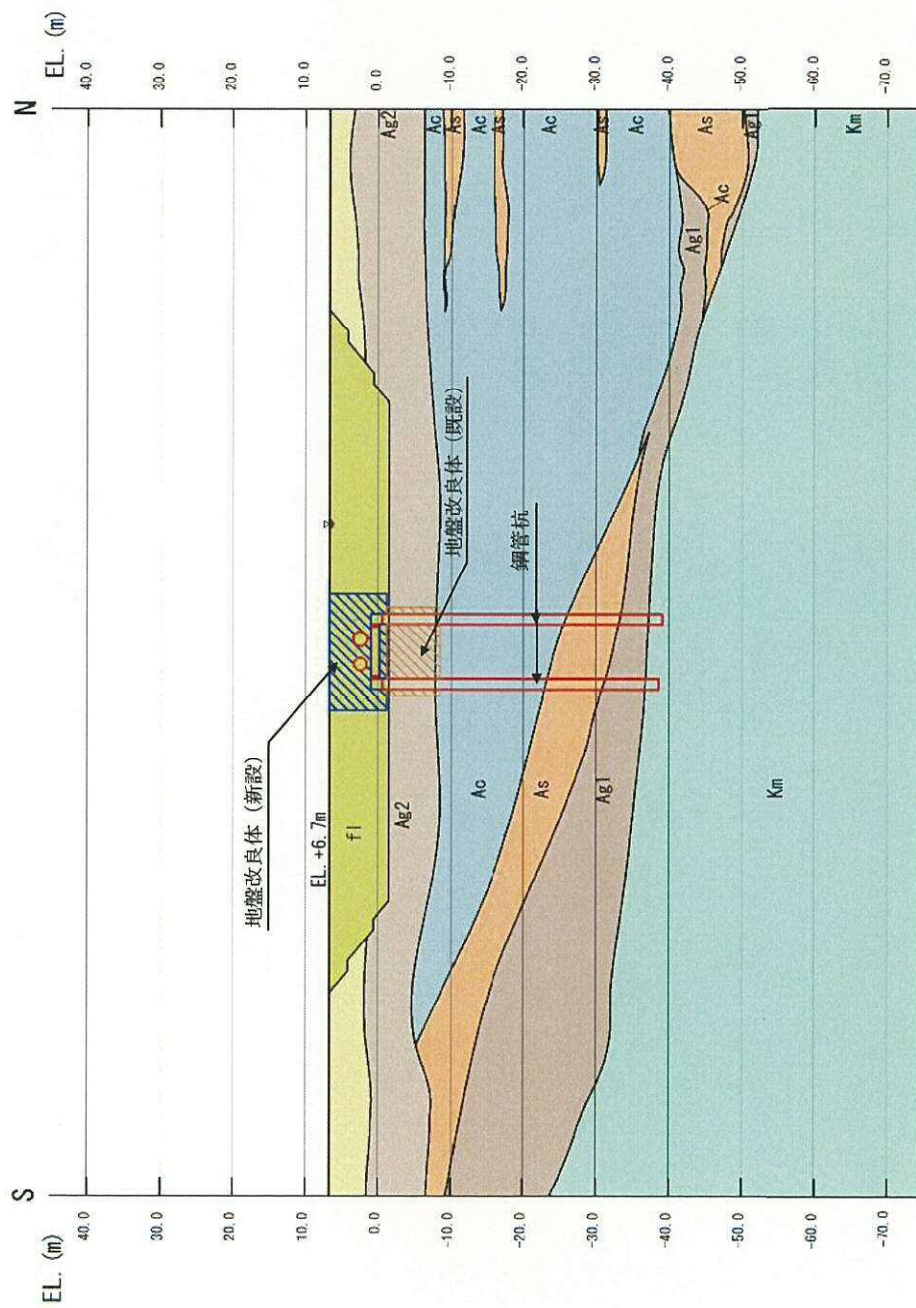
(2) 屋外二重管の横断面図 (B-B断面) (区間 I 候補断面①)
